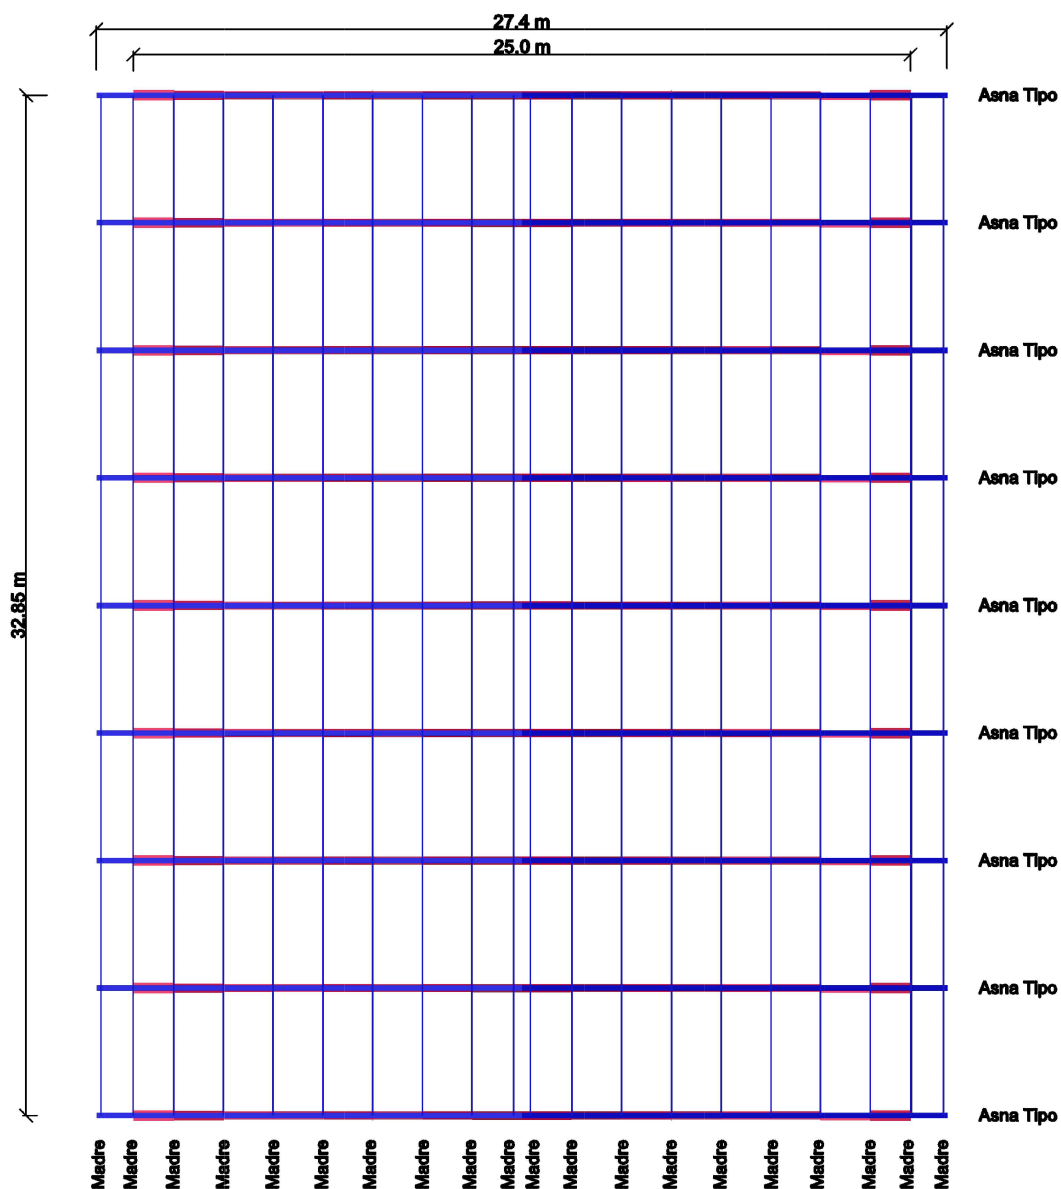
Planta das madres da cobertura - módulo tipo.
